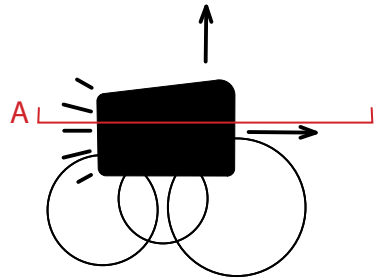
Plan et coupe type de la situation existante au droit de l'implantation du pavillon de l'esplanade avec indication de l'emprise racinaire des platanes à préserver [xy-ar.ch, 2021]
